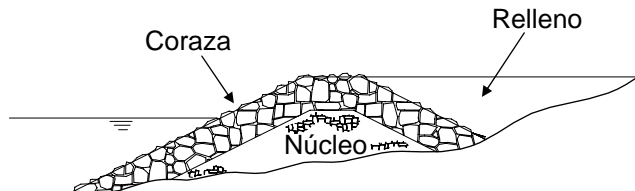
Sección transversal tipo de protección marginal y espigones cortos a base de enrocamientos
